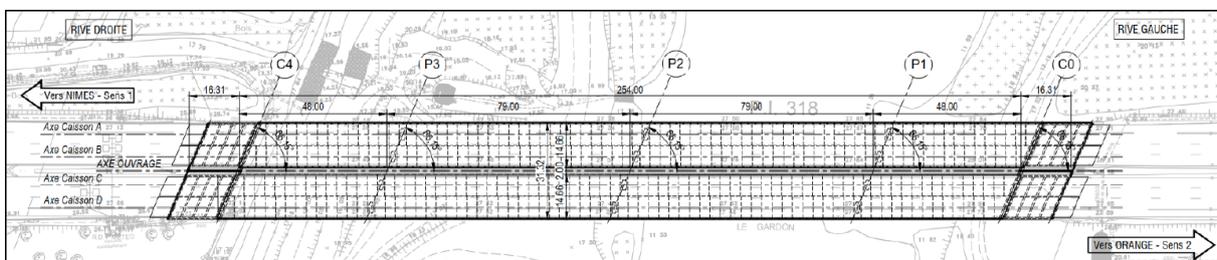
Vue en plan de l'ouvrage (Arcadis, 2022)
